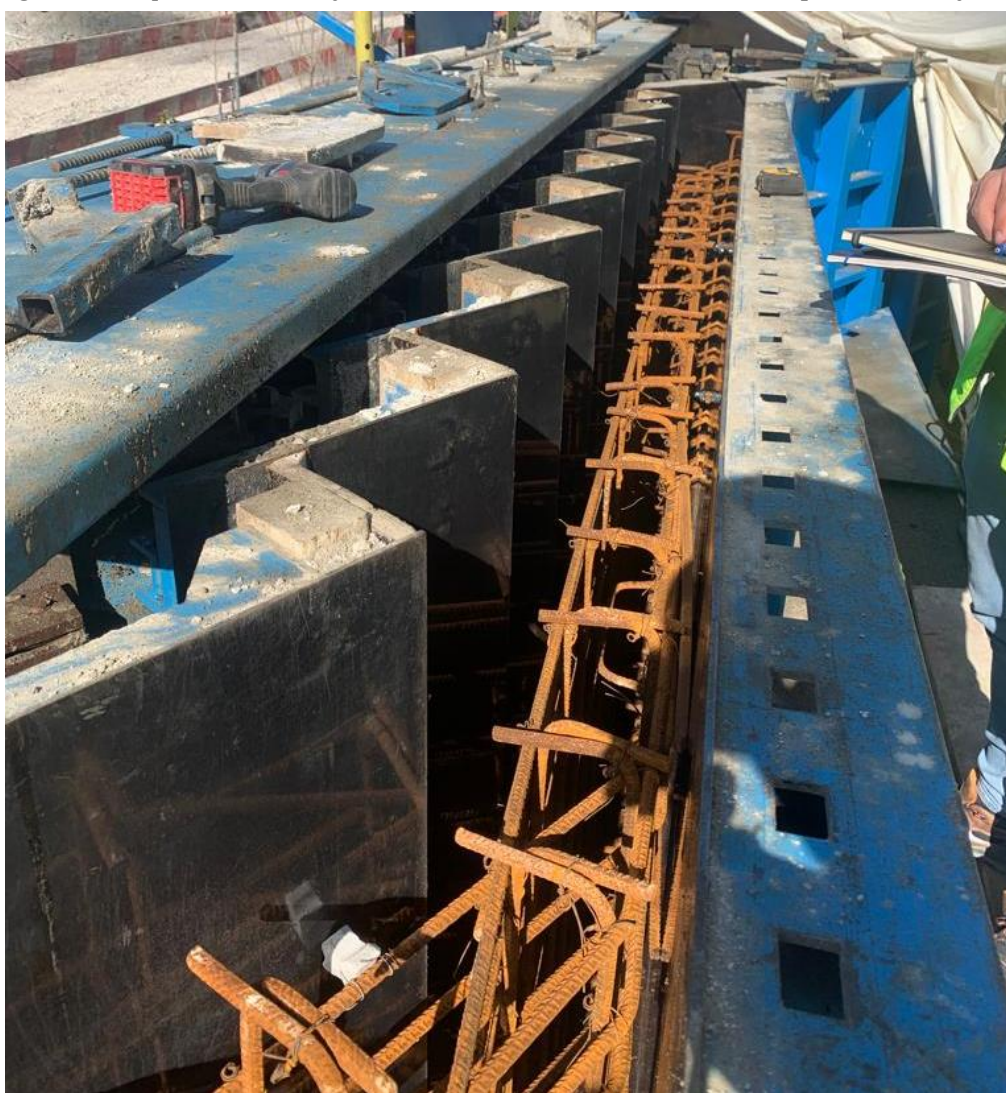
Fase de colocação da armadura da Escada na cofragem.
